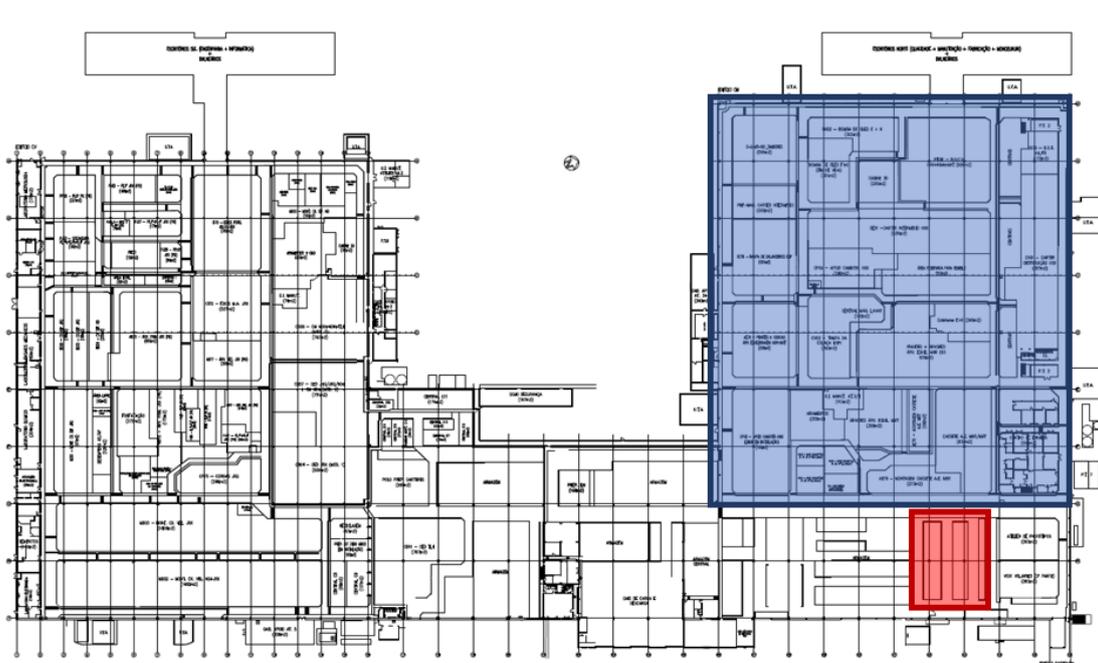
Layout setor dos CM e respetivo armazém (Azul - linhas de fabricação, Vermelho – armazém).
